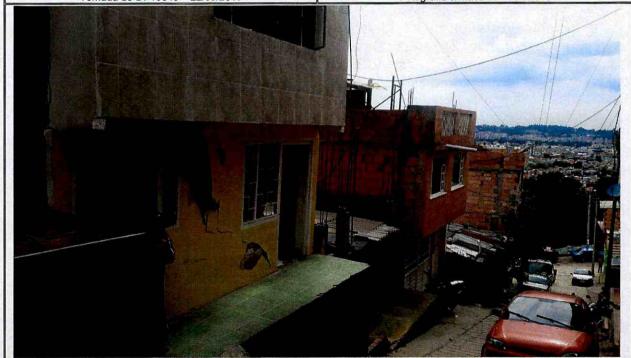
Viviendas que pudieran resultar afectadas (3, 4 y 5) por el posible colapso de la vivienda emplazada en el predio 2, ubicados en la Calle 164 A con Carrera 3, Desarrollo Santa Cecilia de la Localidad de Usaquén
